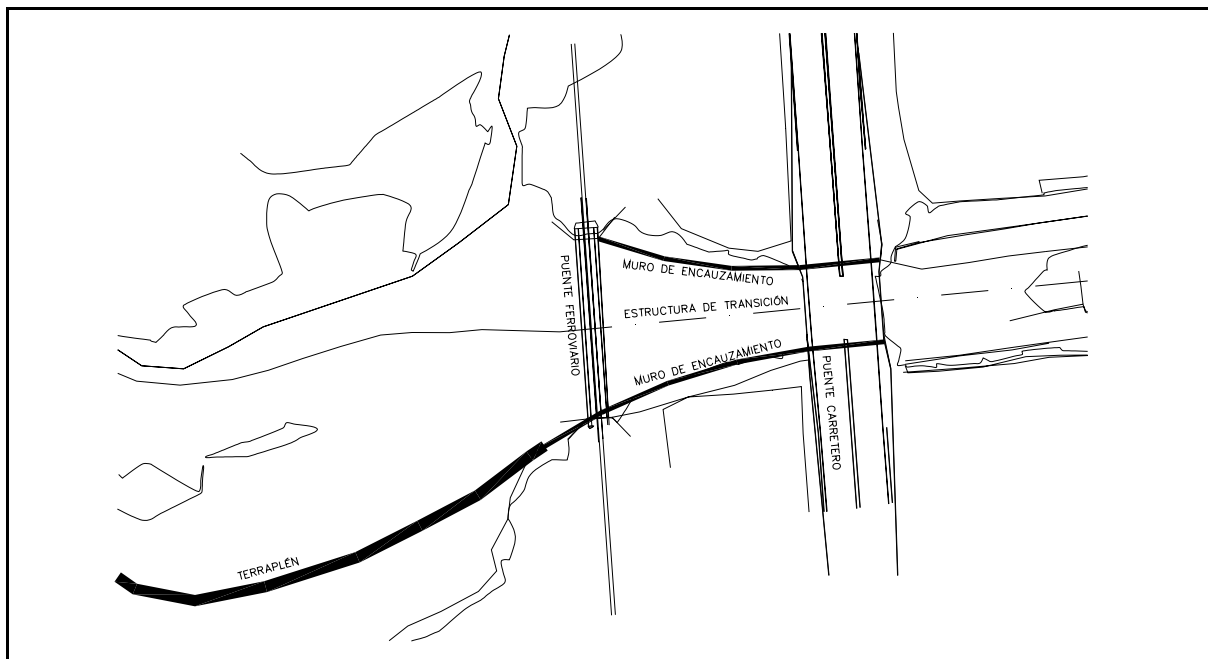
Plano en planta de ampliación del puente carretero , ancho 22 m, muro entre puentes y muro guia aguas arriba puente ferroviario.
